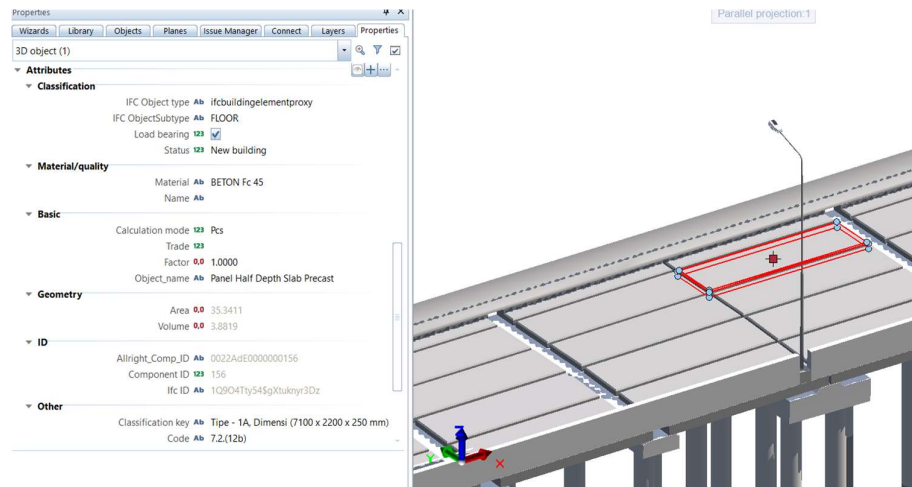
Denah Posisi *Half Slab* EJ5 – P1
